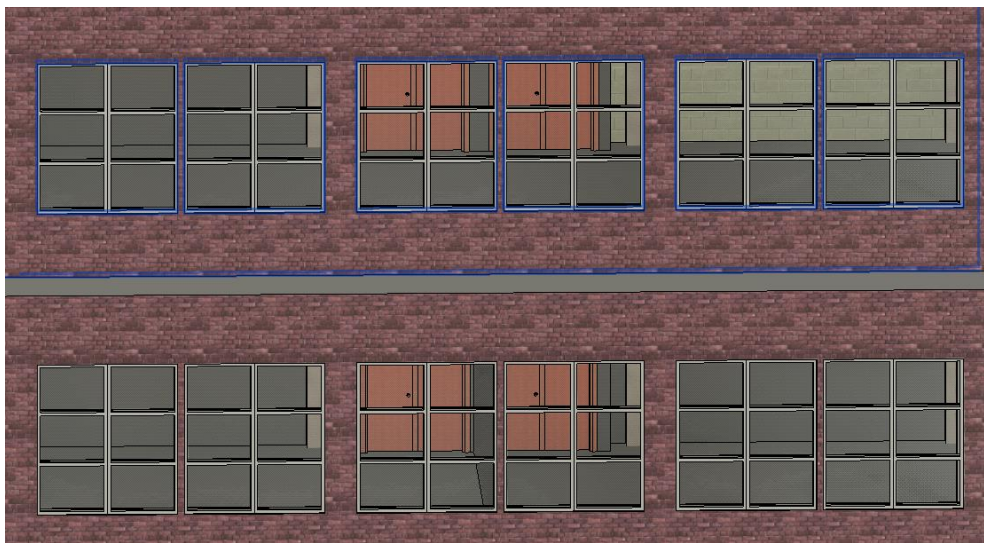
Fachada con los conjuntos de ventanas colocados, en el piso superior la estructura de 3x12 da luz a toda el aula, mientras que en la inferior el conjunto se ha dividido en 2
